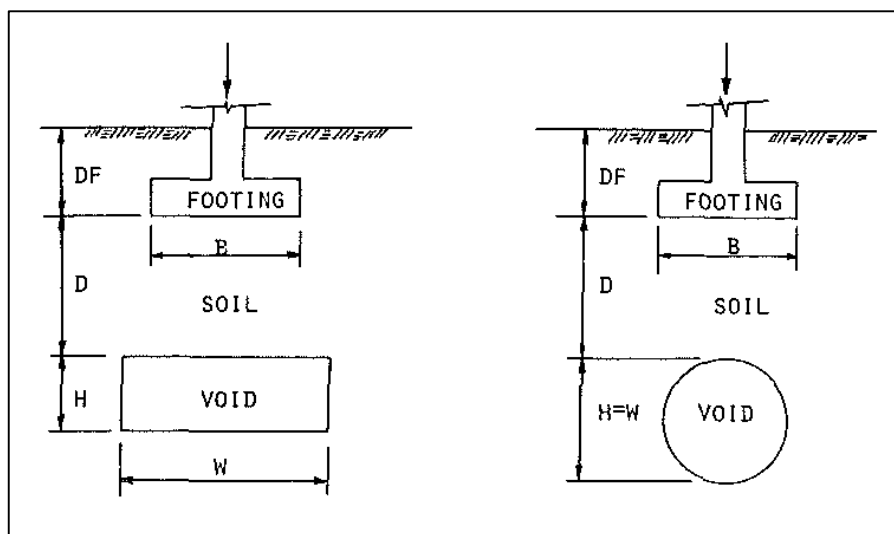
Semelle filante centrée sur un vide continu (Baus & Wang, 1983).
